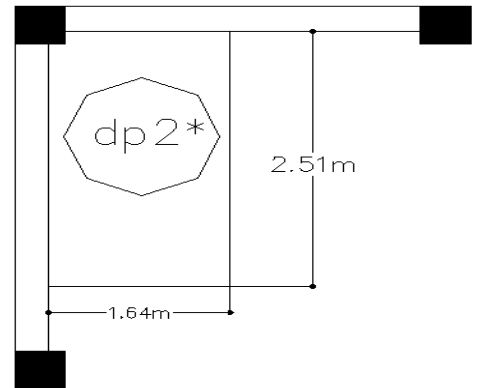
dalle pleine sur deux appuis terrasse accessible.
